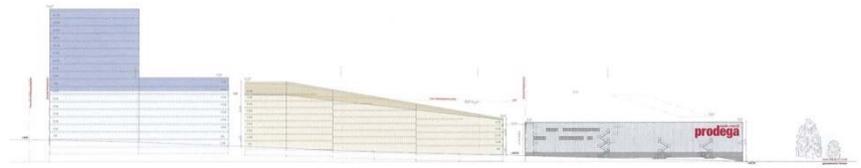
Machbarkeitsstudie Bebauung Variante A Begrünung, Burkhalter+Sumi Architekten, Ansicht/Schnitt West (Autobahn)
